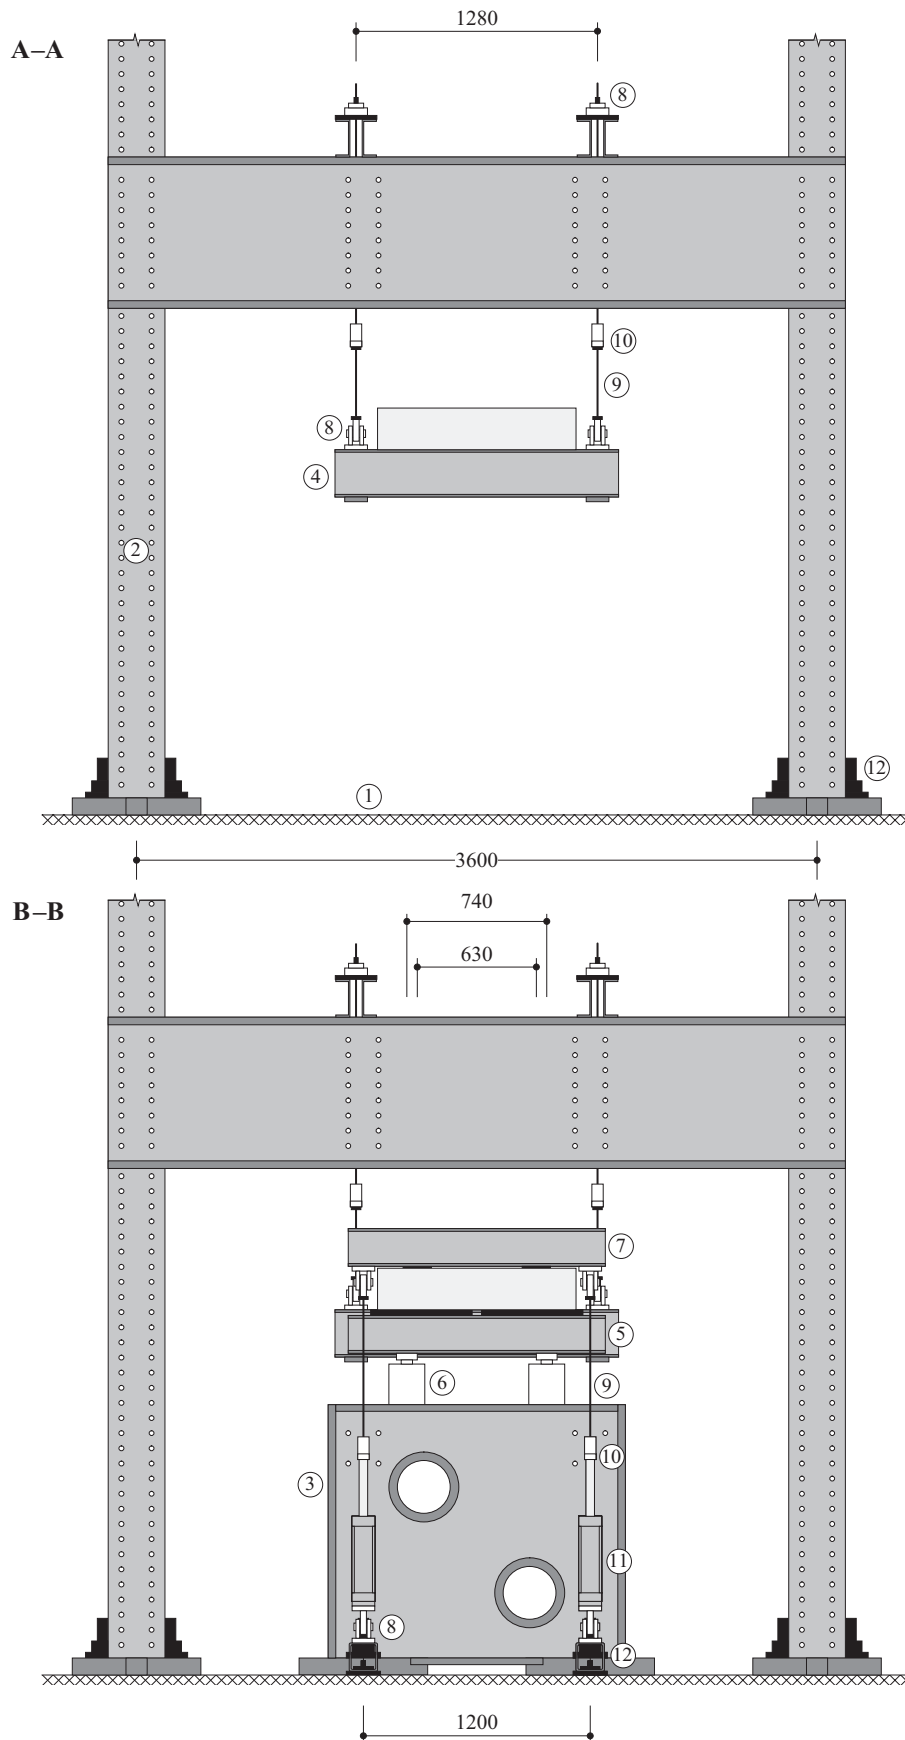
Schnitte von Bild 3.6; Abmessungen in mm.
